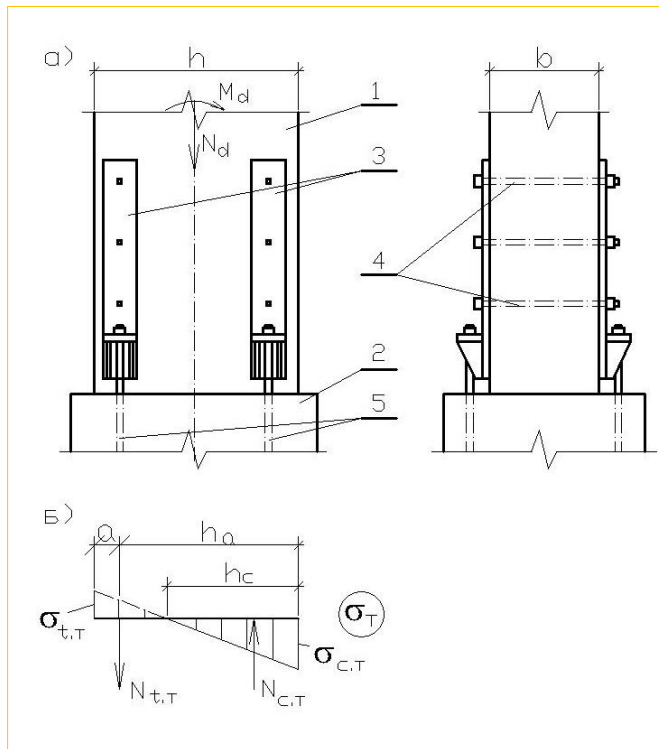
Узел защемления колонны в фундамент со стальными столиками и анкерными болтами:
